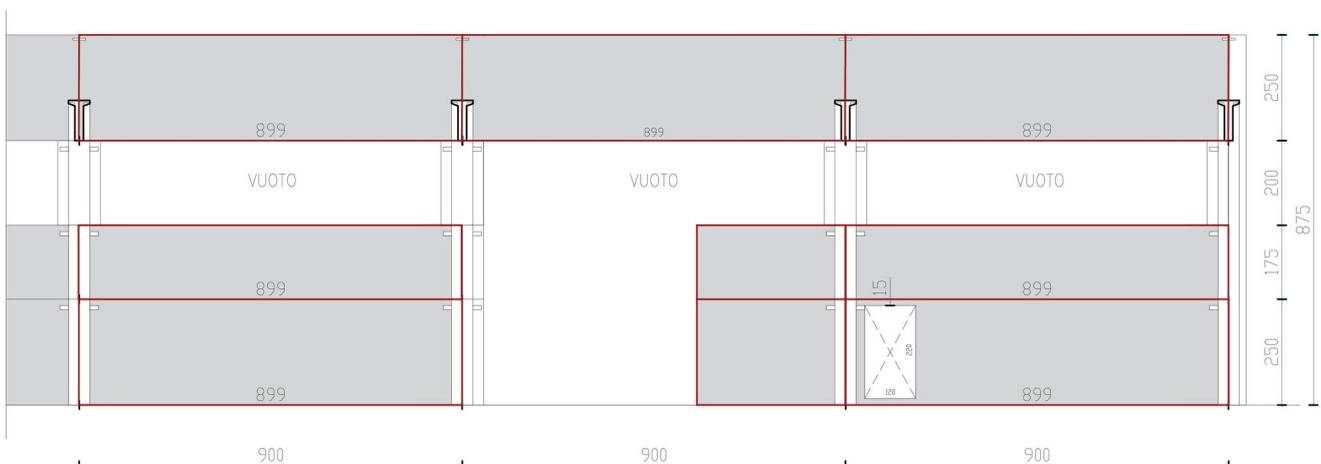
Prospetto della parete sud-est con individuazione dei pannelli prefabbricati che compongono la facciata.
